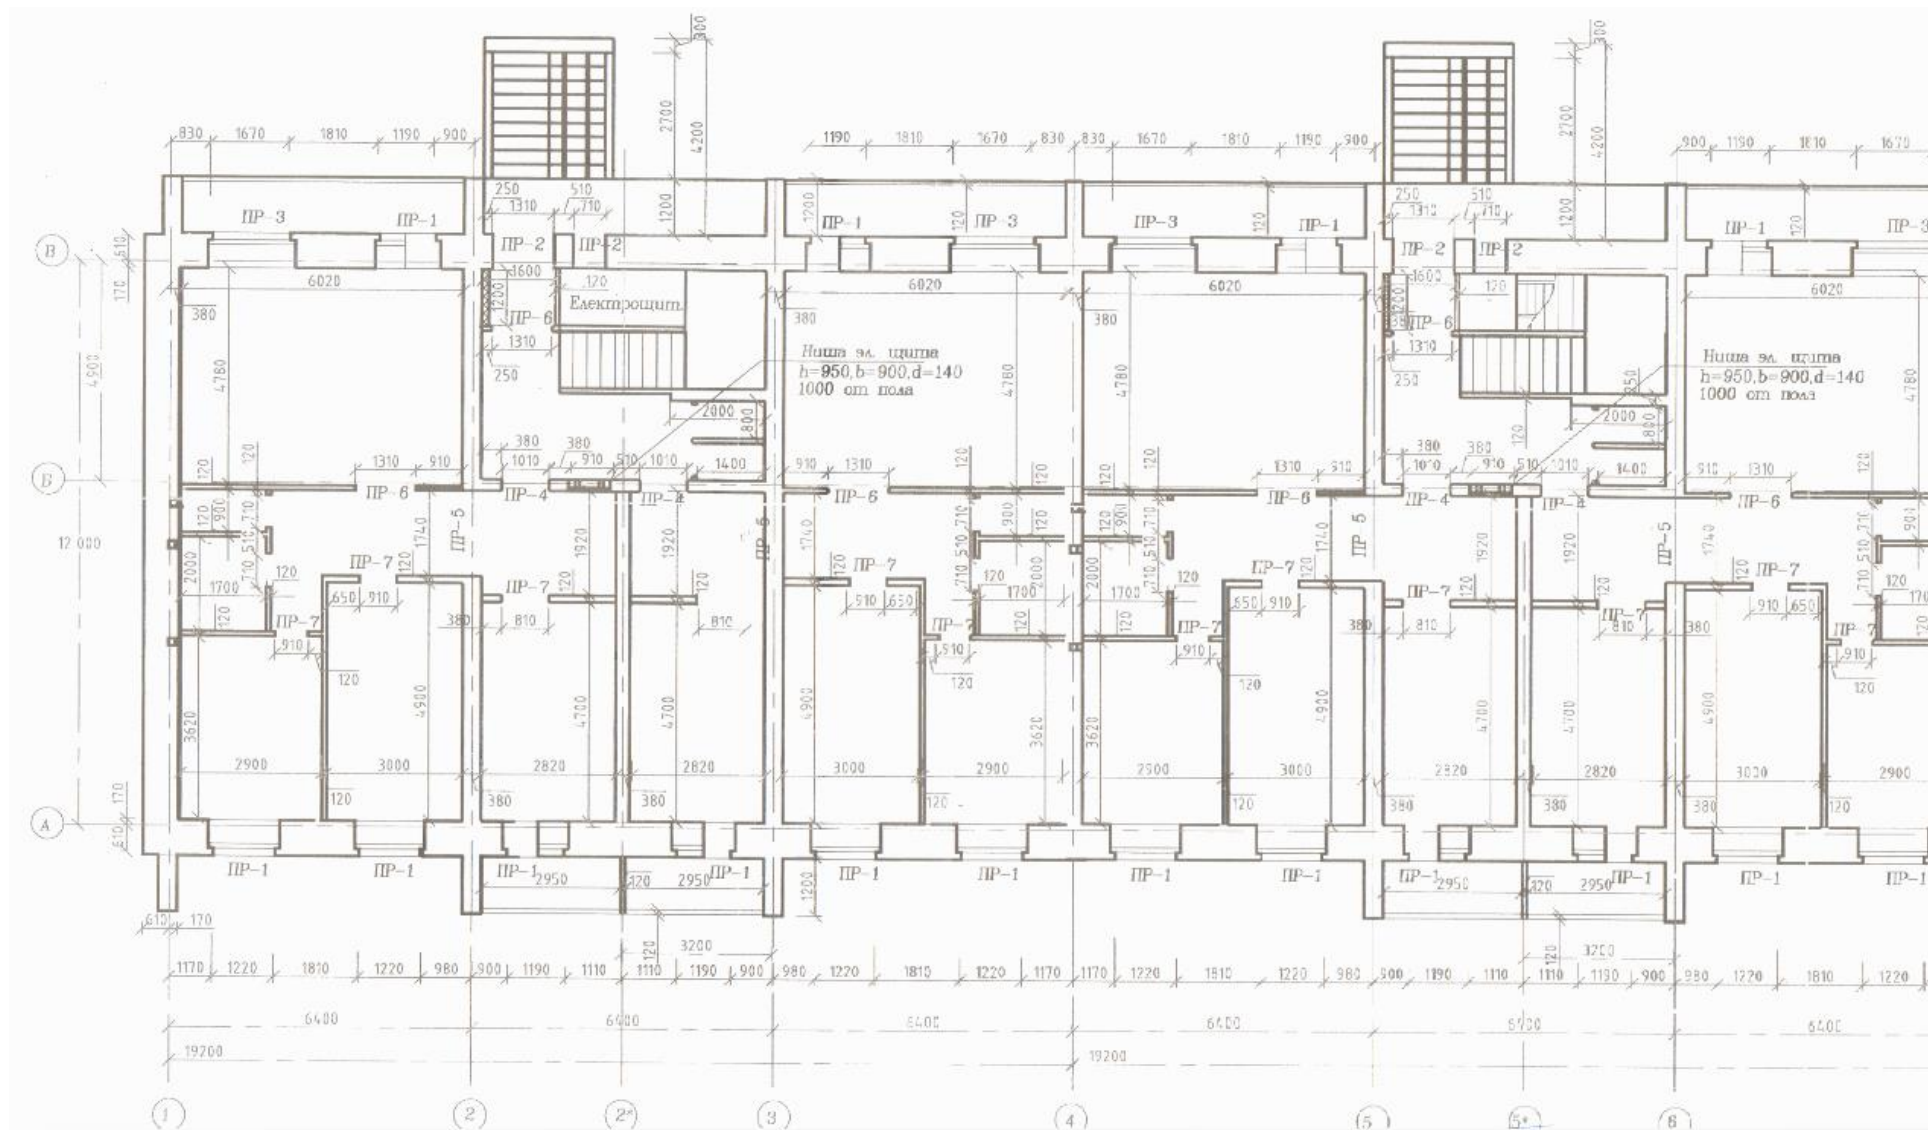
Кладочный план 1-го этажа типовой блок секции.
